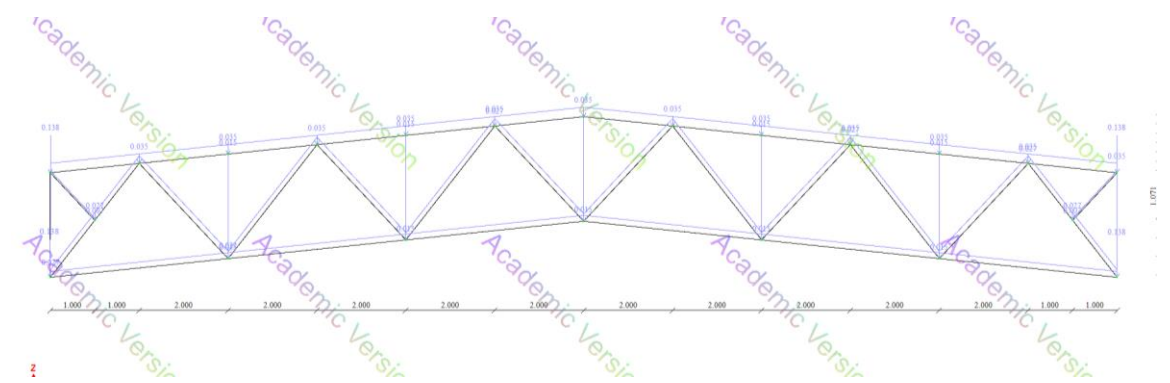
Розрахункова схема ферми за чотирнадцятим завантаженням
